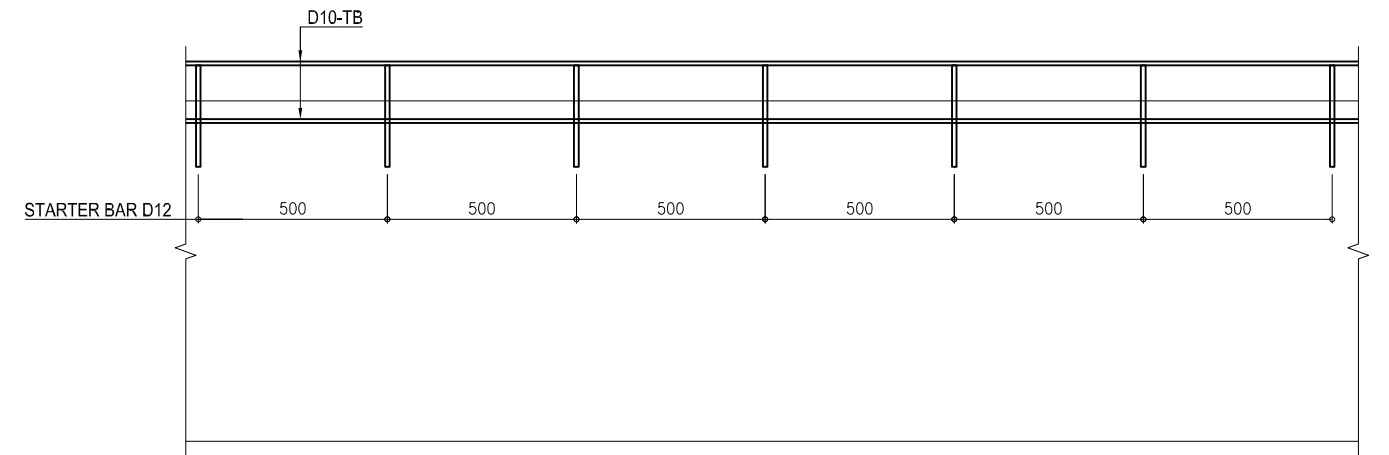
DETAIL OF REBAR D10 / CHI TIẾT THANH THÉP D10
